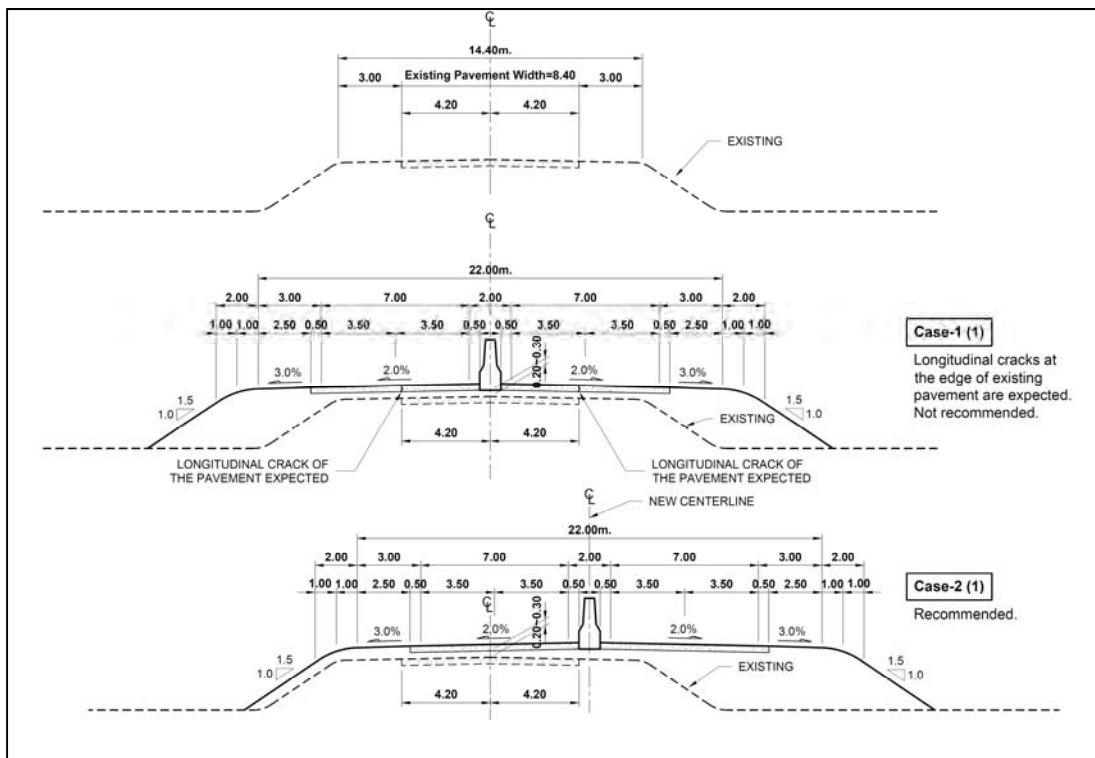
標準横断面パターン-1: 既存舗装幅= 8.4m
